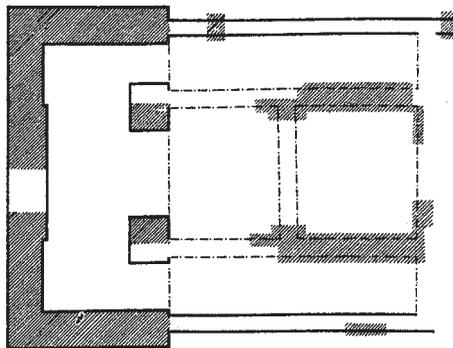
Rochlitz, Kunigundenkirche, Grundriss der Westturmanlage mit Rekonstruktion des Langhauses nach den Grabungsergebnissen von 1936, M 1:400
